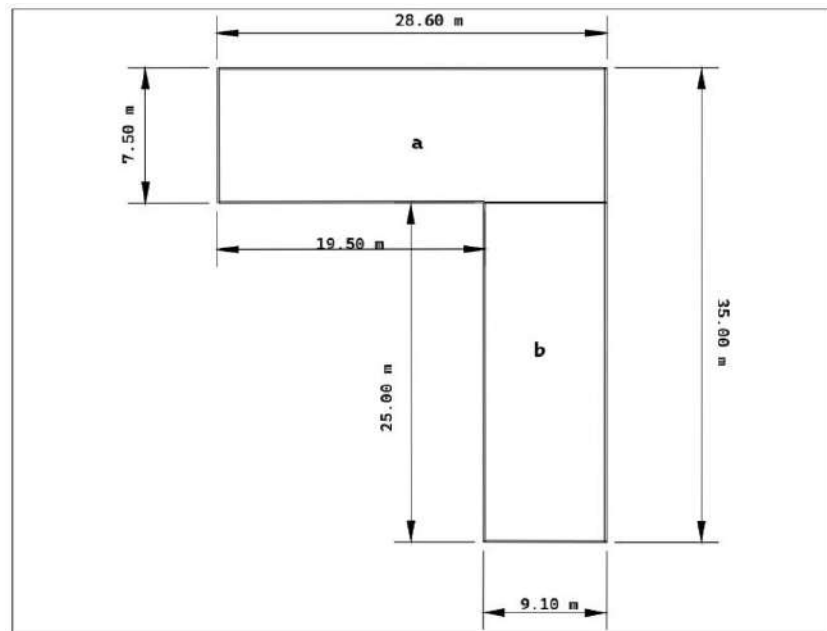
Plano del levantamiento del área del Colegio Instituto Murgas
